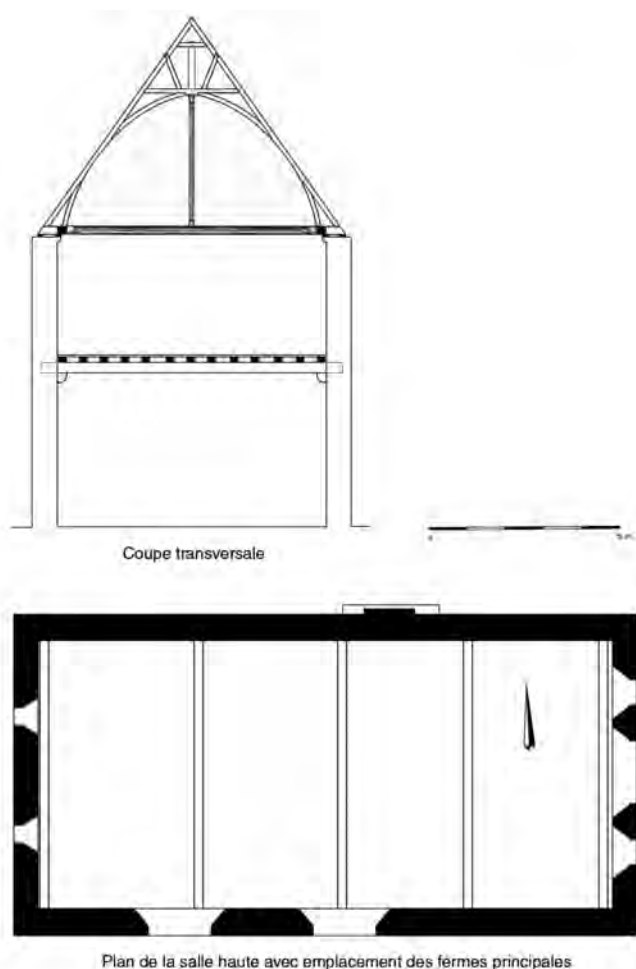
Coupe transversale et plan de la salle haute (1226d).
